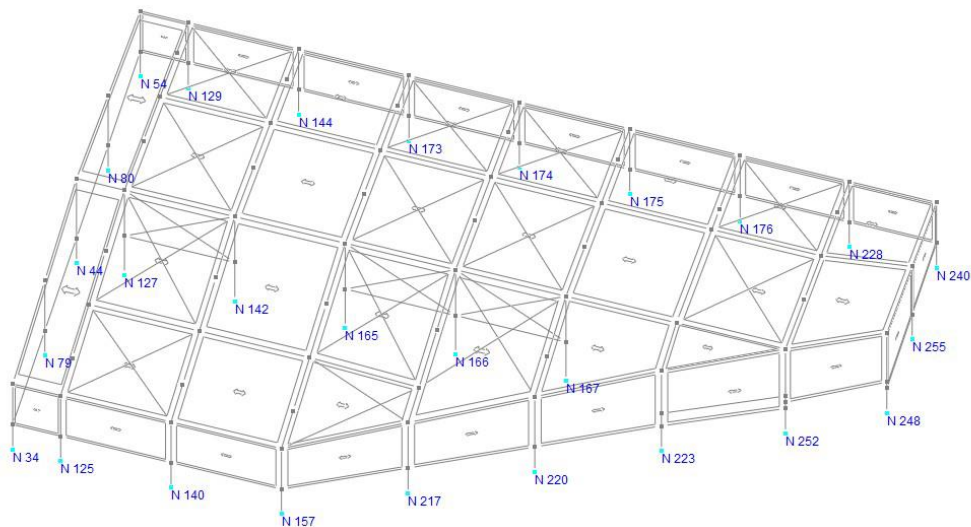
Ubicación de zapatas aisladas en proyecto
